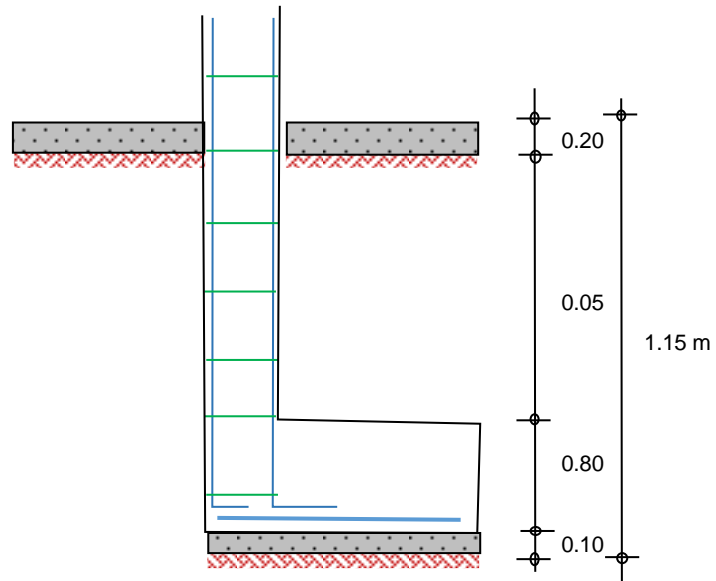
Detalle de sección de zapata excéntrica (Estructura 2).
